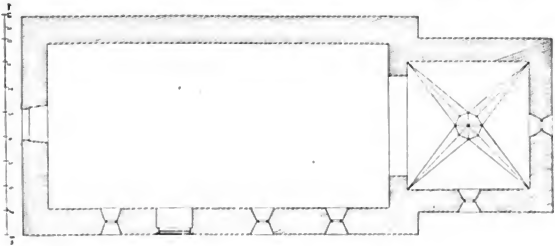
Dobronitz. Grundriss der Kirche.
